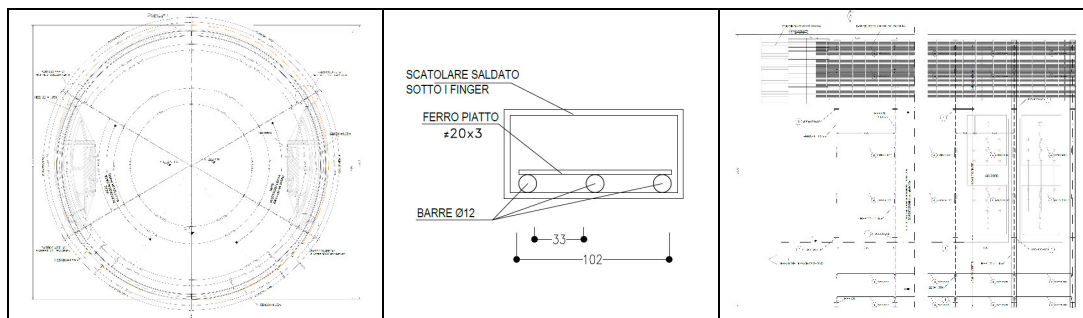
Sezione tipo FMV – Sezione trasversale (a), particolare sistema di presostegno del cavo (b) e sezione longitudinale (c)
